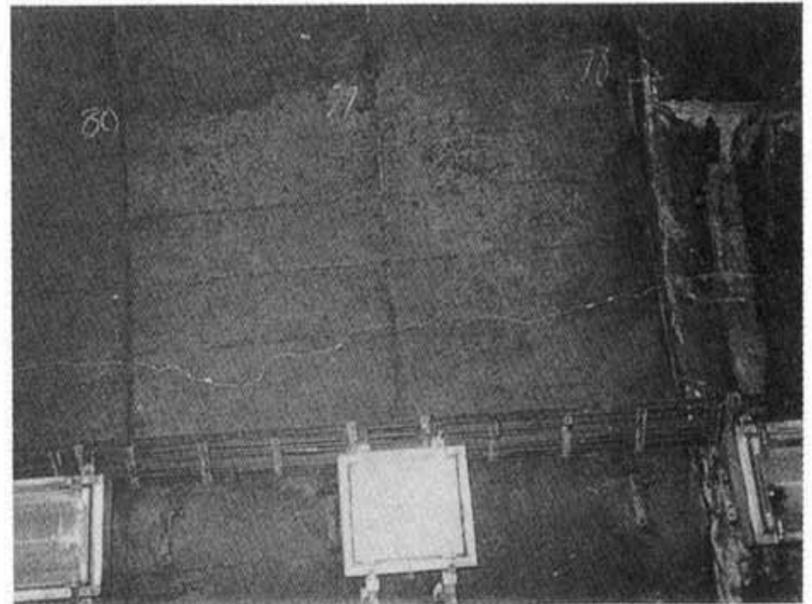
月見山トンネル・縦断方向ひび割れ
